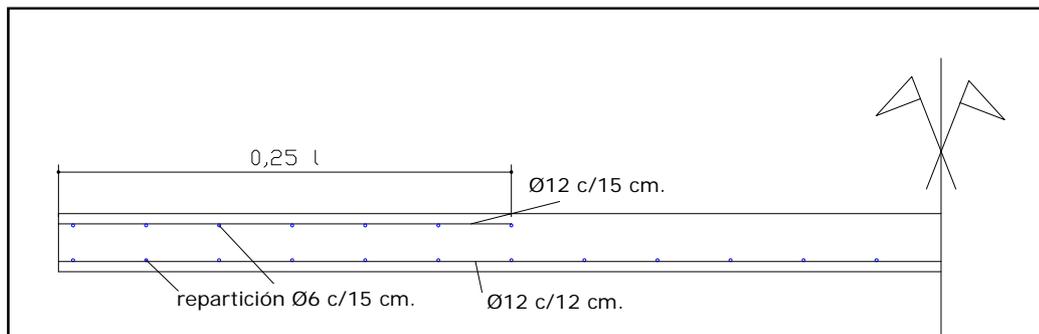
Esquema de armado de la losa de pasillo en tribuna n° 4 1° Piso
